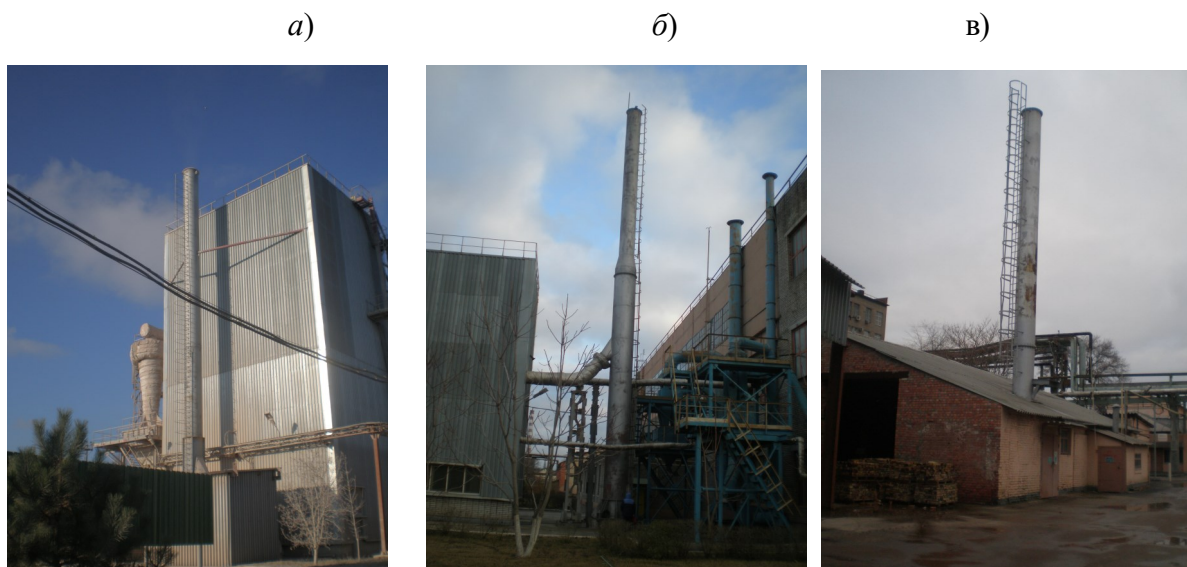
Общій вид металлических дымовых труб мартеновского цеха: дымовой трубы высотой 25.00м газоочистки печи КС-55 – (а); дымовая труба высотой 24.00м газоочистки сушильного барабана ШОС – (б), дымовая труба высотой 17.80м печи обжига огнеупоров – (в).
